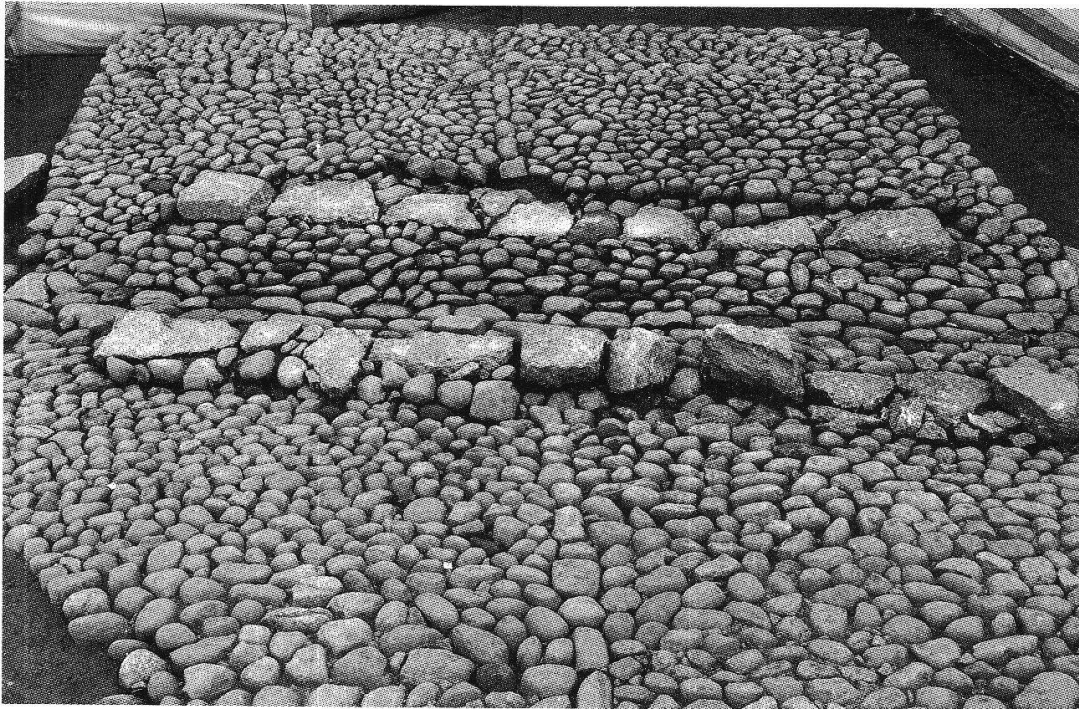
PAYERNE - Route de Bussy. Le fond pavé du passage à gué, remplacé ensuite par un canal dallé. (Photo Archéodunum)
